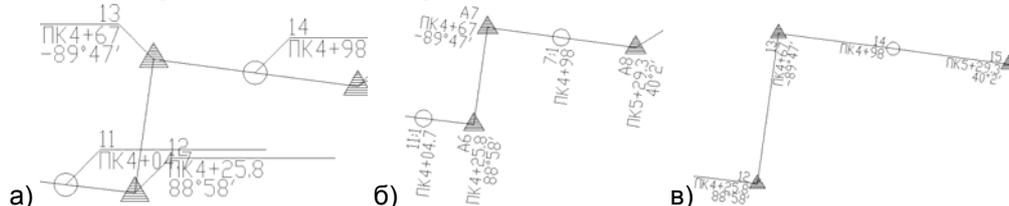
Примеры вывода надписей на план на выносках(а) поперек линии (б) или вдоль линии (в).
